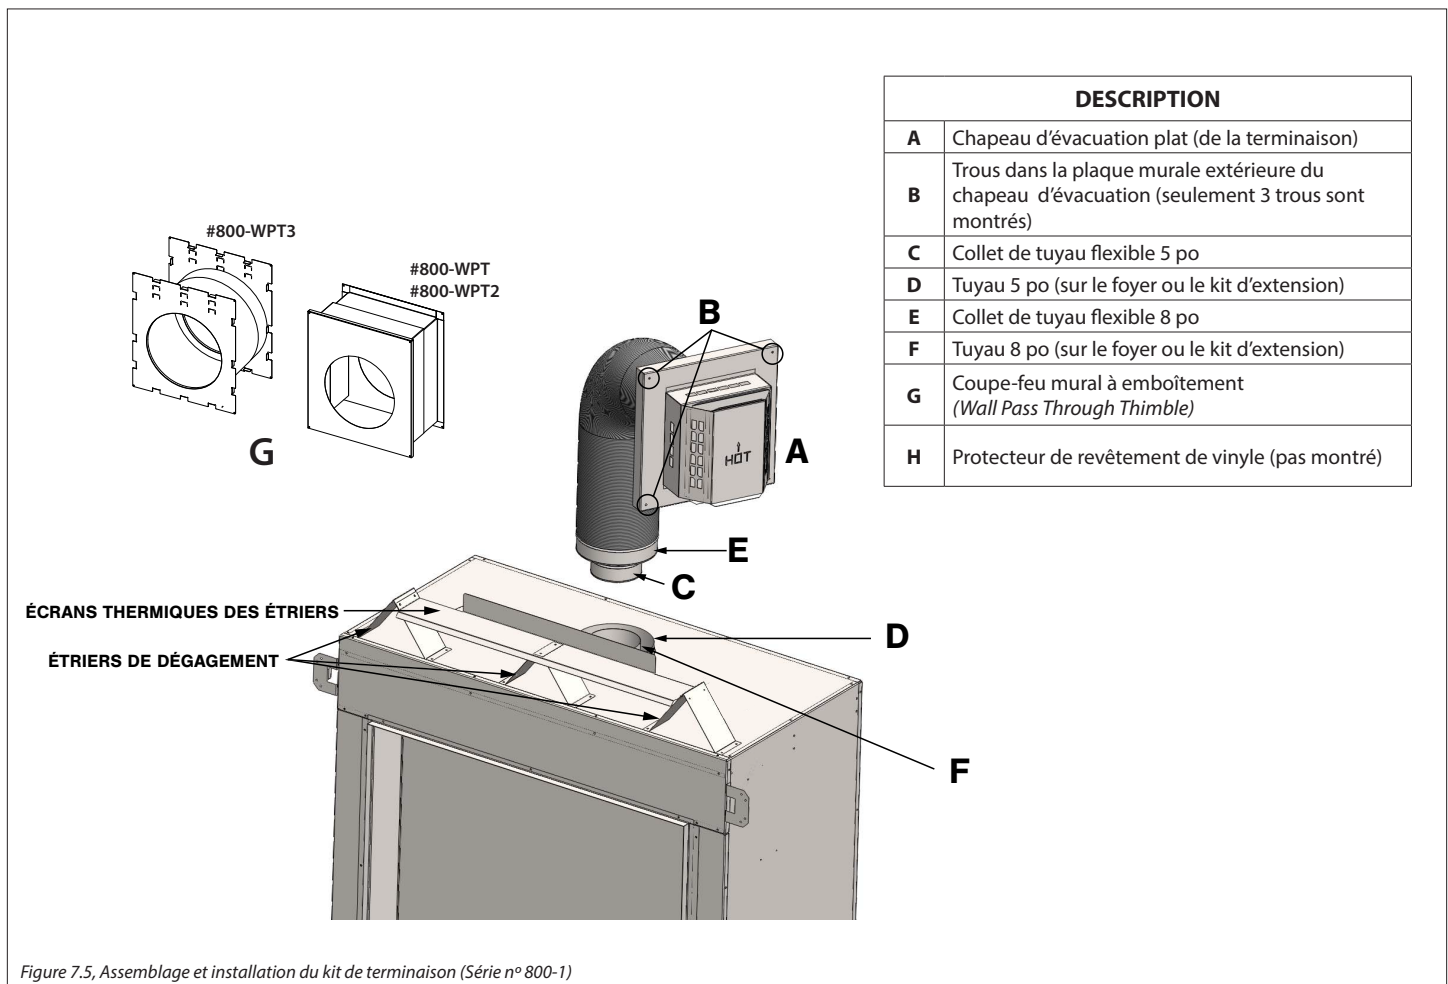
, Assemblage et installation du kit de terminaison (Série n° 800-1)
